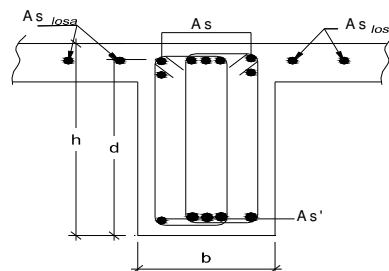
Distribución del refuerzo por flexión en vigas
